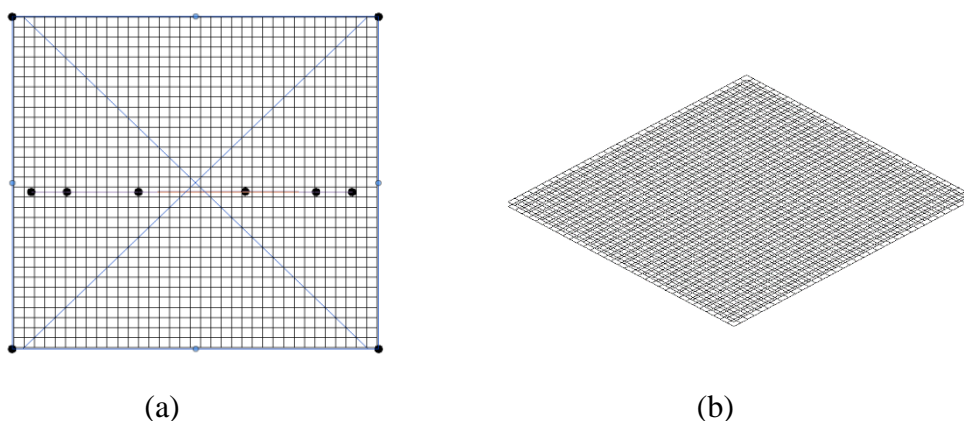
Imagens da armadura da laje: (a) vista superior; (b) vista em perspectiva;
